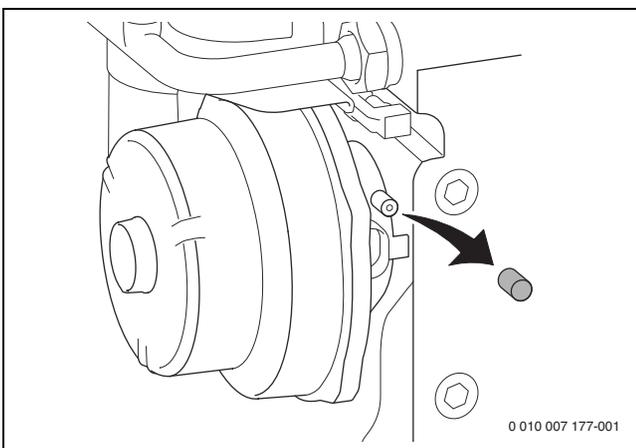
Tubulure de mesure sur le dispositif de mélange
